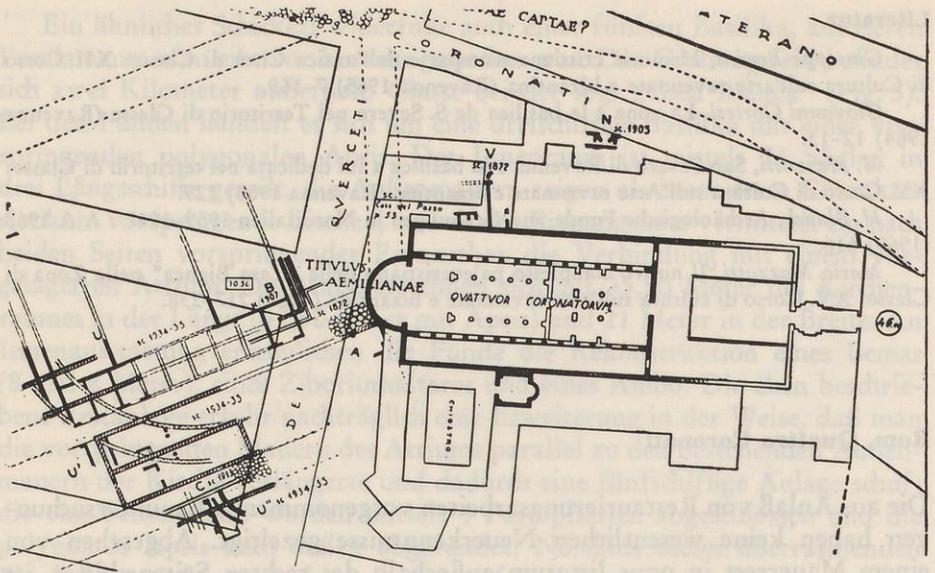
Lage und Anlage der Titelkirche. Grundriß
